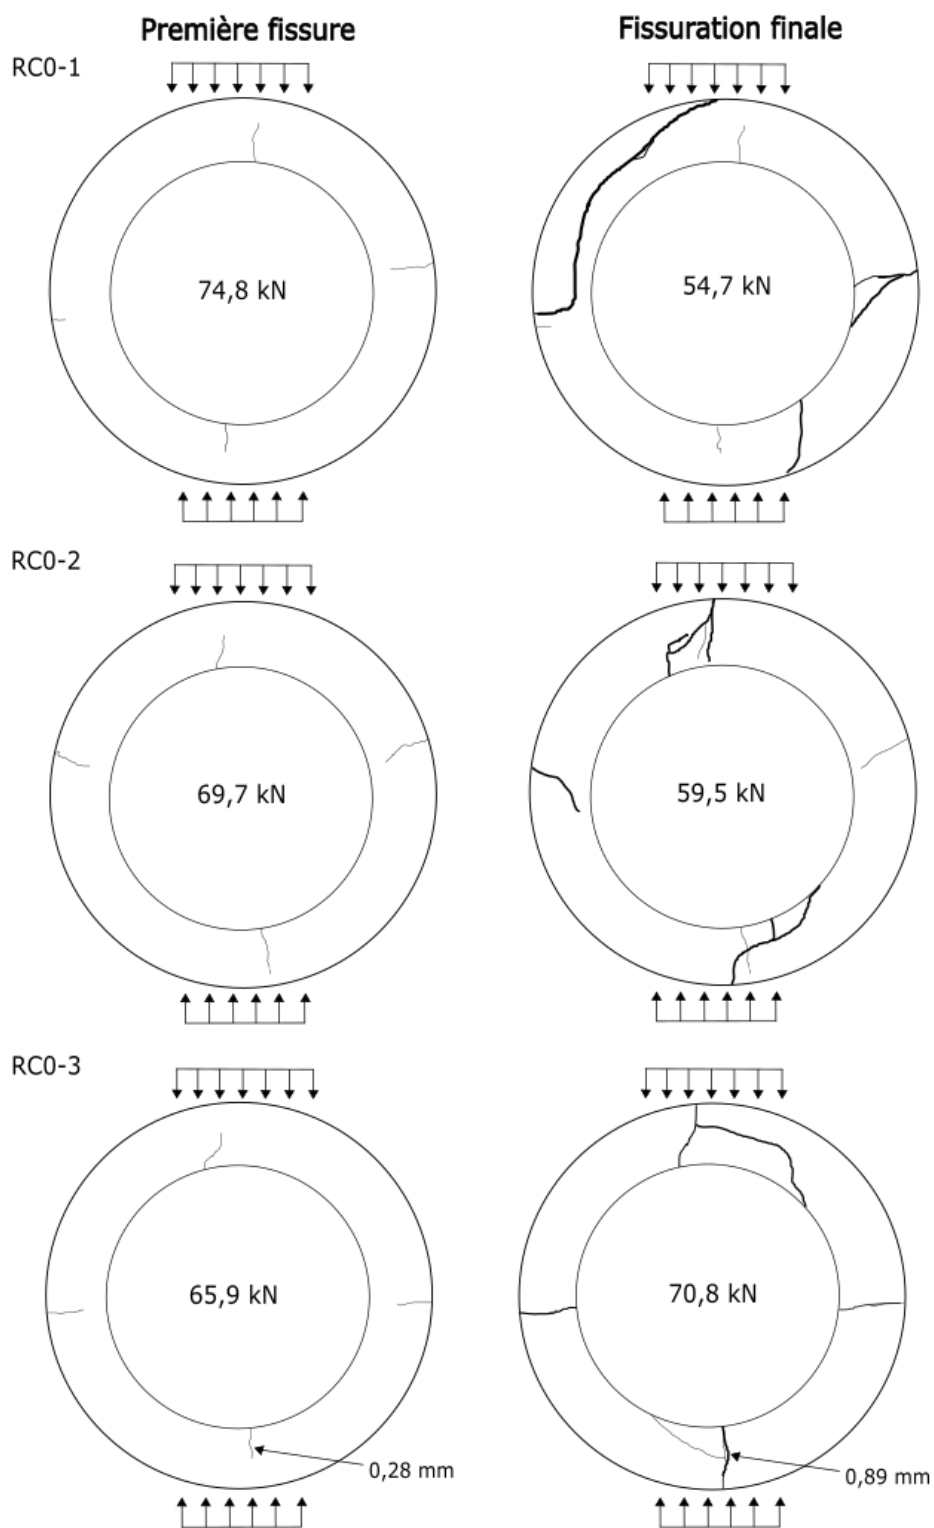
Premières fissures et fissuration finale des sections de tuyaux avec 0% de RB
